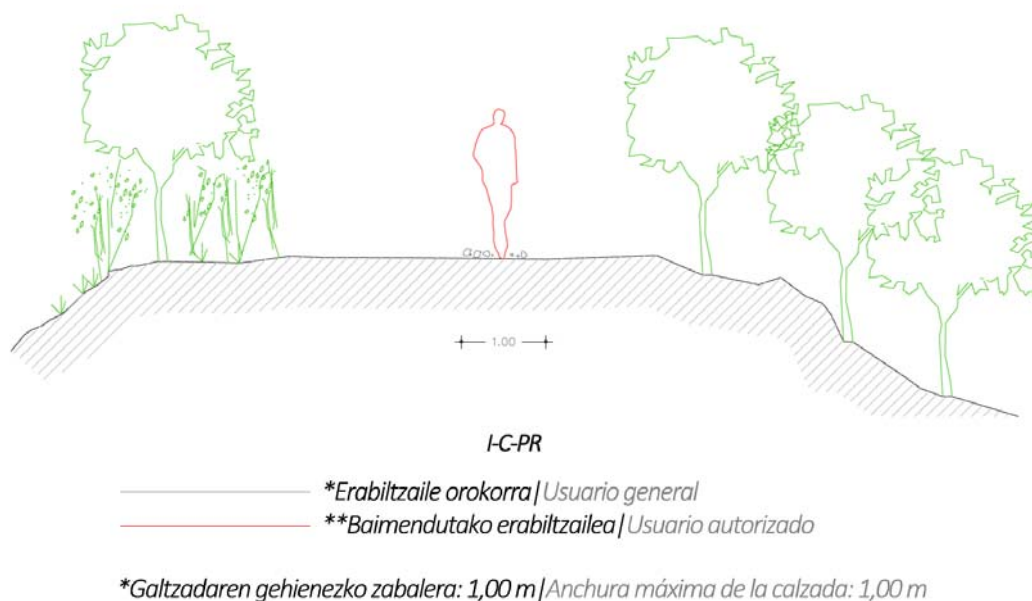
Sección tipo de las vías de comunicación de tipo I-C-PR senderos en zonas protegidas. Fuente: Plano O0.3. Ordenación general de las infraestructuras de comunicación. Plan Especial para la protección y conservación del Monte Ulía. Octubre 2018.
